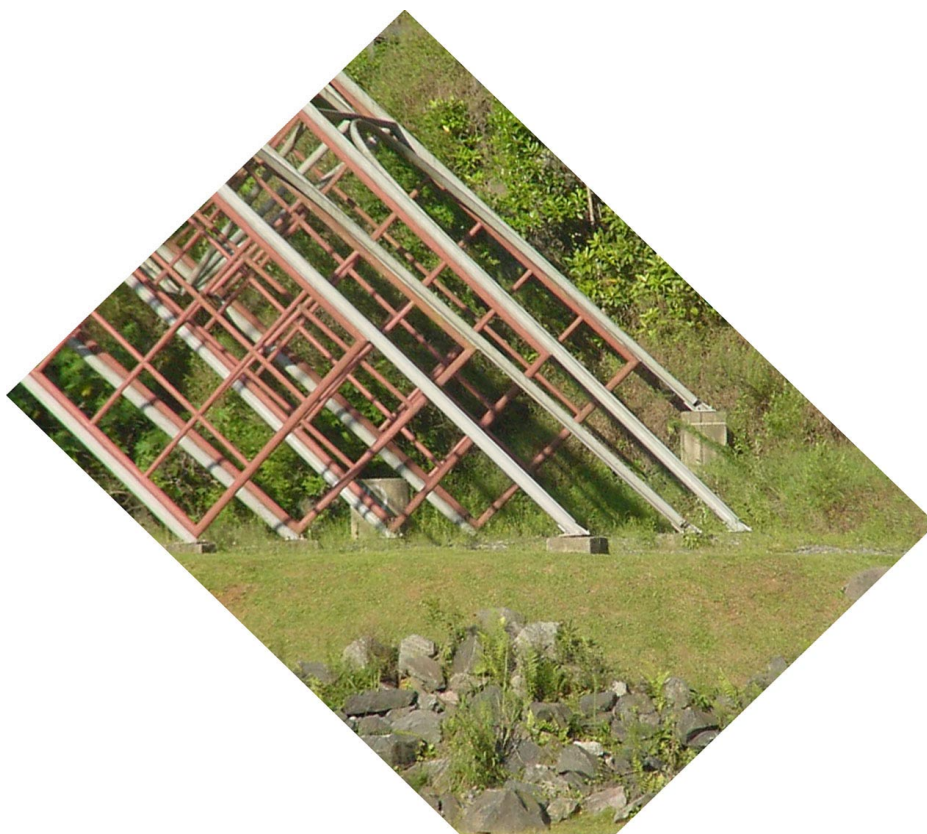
Detalhe da ligação das estruturas diagonais com o terreno
